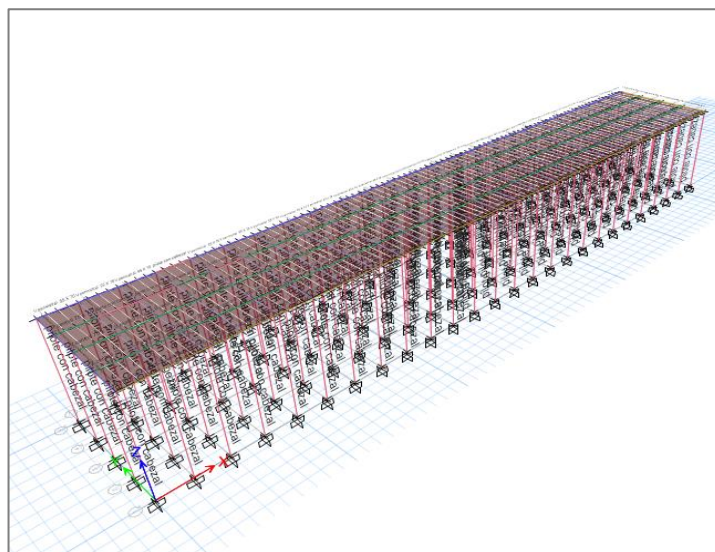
Modelo tridimensional de pórticos de hormigón armado; Fuente autor
